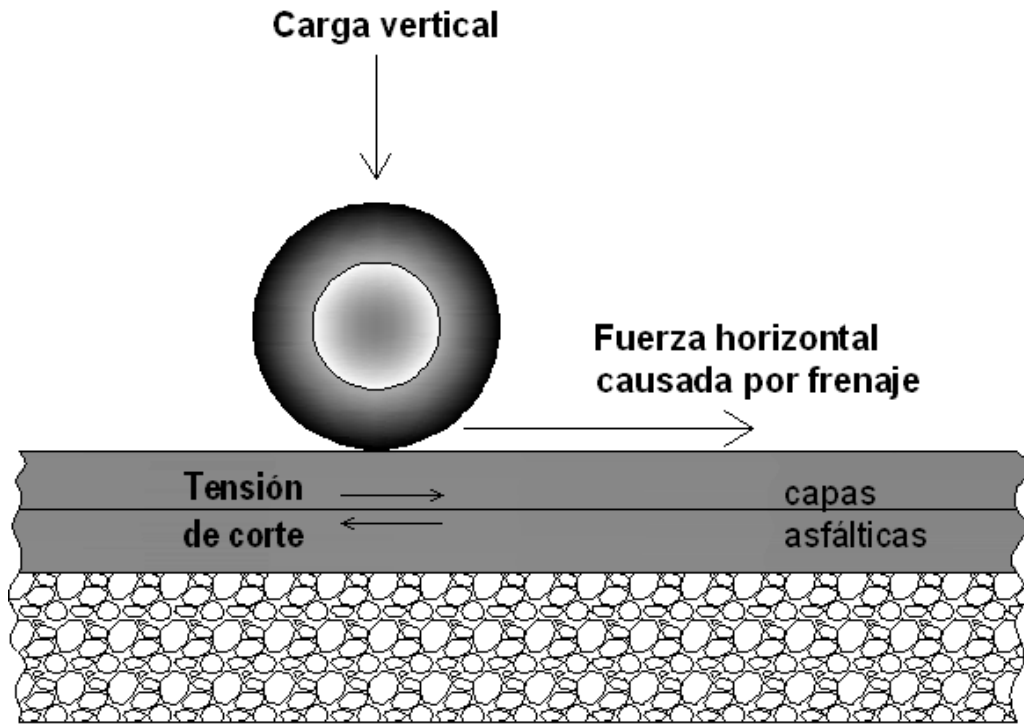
Esquema de esfuerzo horizontal sobre superficie del pavimento.
